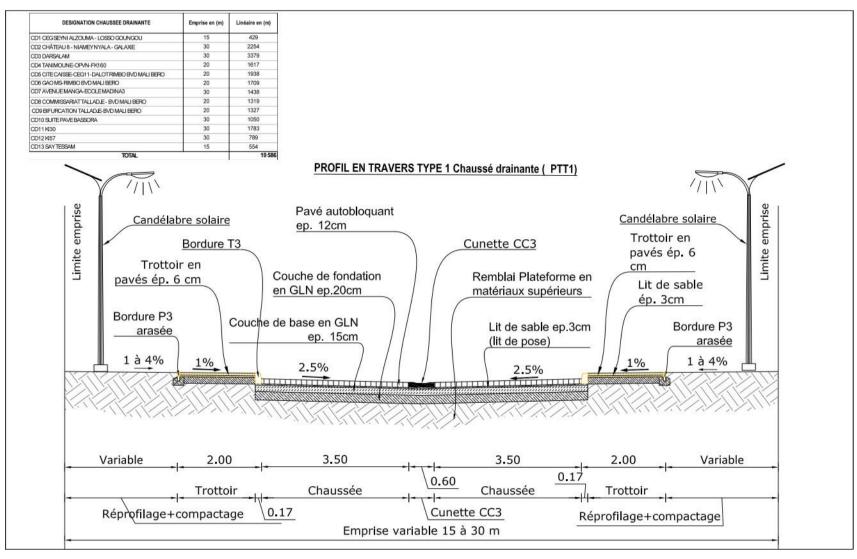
Profil en travers type 1 – Chaussée drainante (PTT-1)
